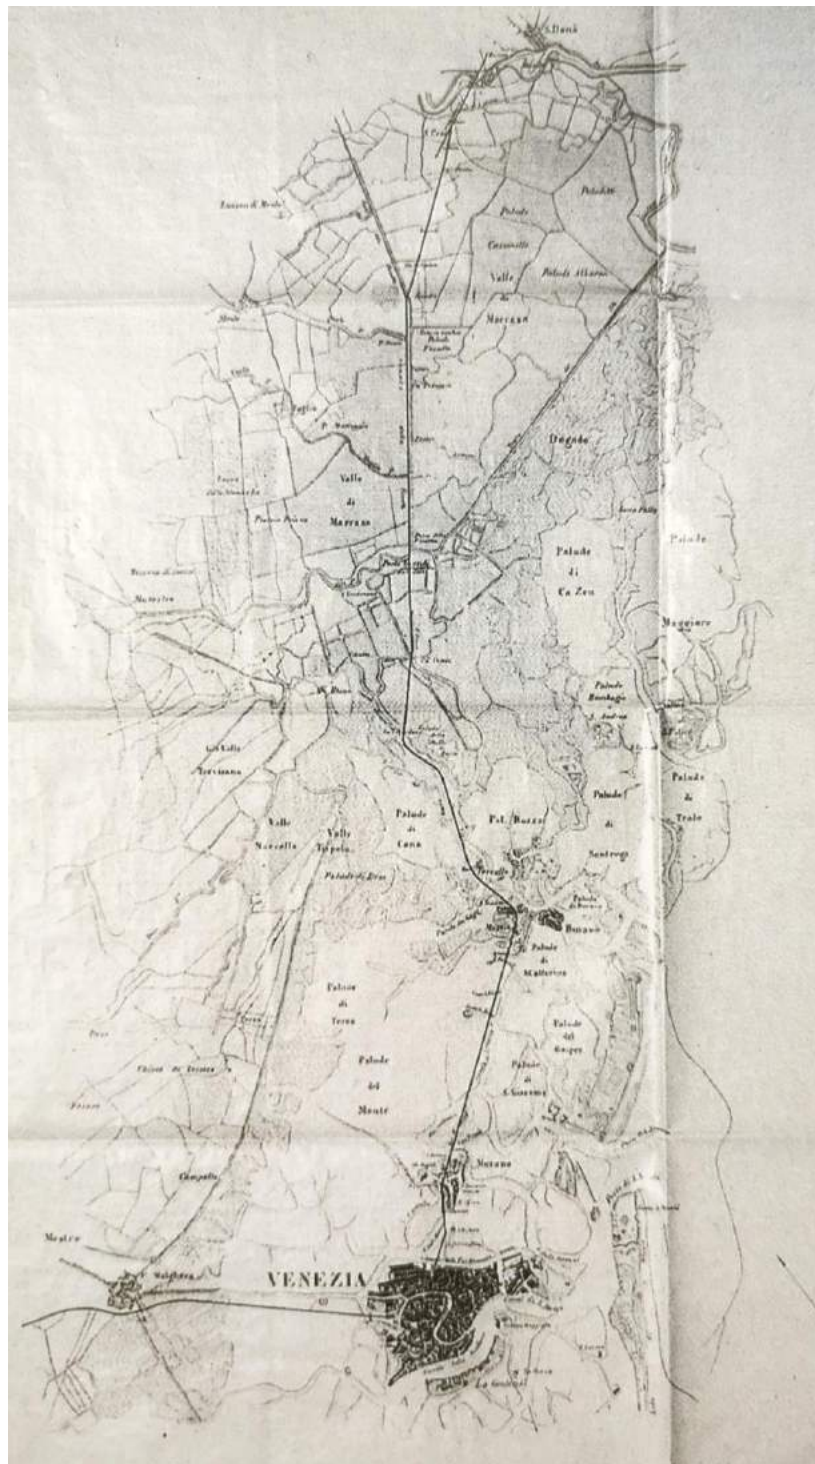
G. Colle, Planimetria Generale, 23 luglio 1881,
